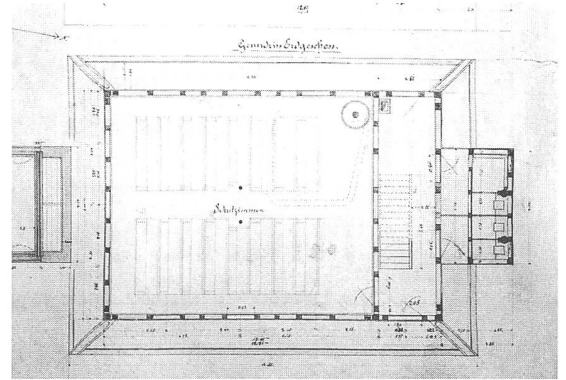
Oeschenbach, Primarschulhaus. Grundriss des Erdgeschosses, Schulzimmer mit zwei Bankreihen, 1895, Walter Christen. (Gemeindearchiv Oeschenbach)
